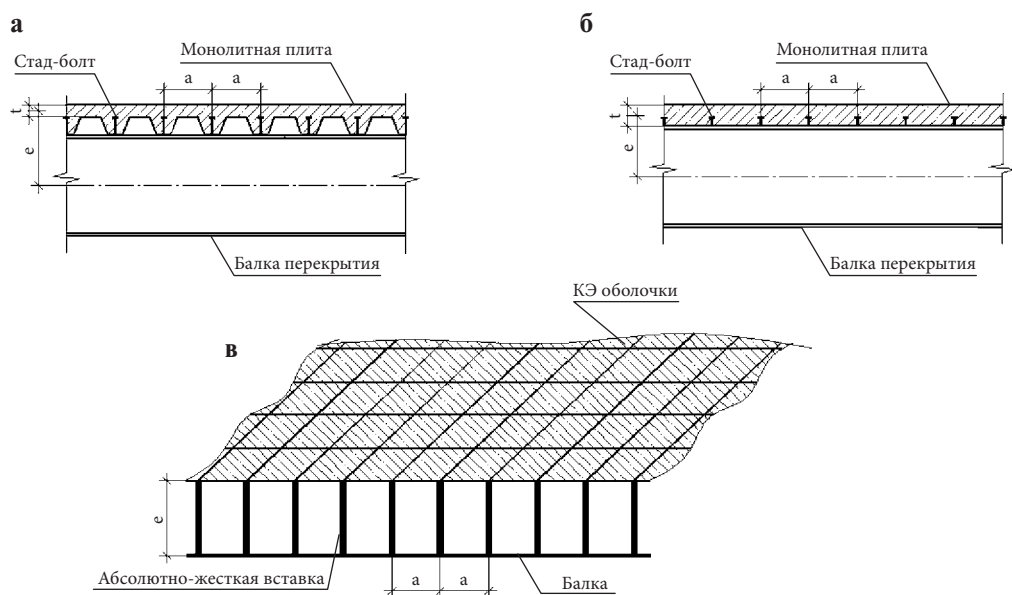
Расчетная схема сталежелезобетонного перекрытия с монолитной плитой по профилированному настилу: а) конструкция перекрытия с монолитной плитой по профилированному настилу; б) конструкция перекрытия с монолитной плитой по съемной опалубке; в) расчетная схема
